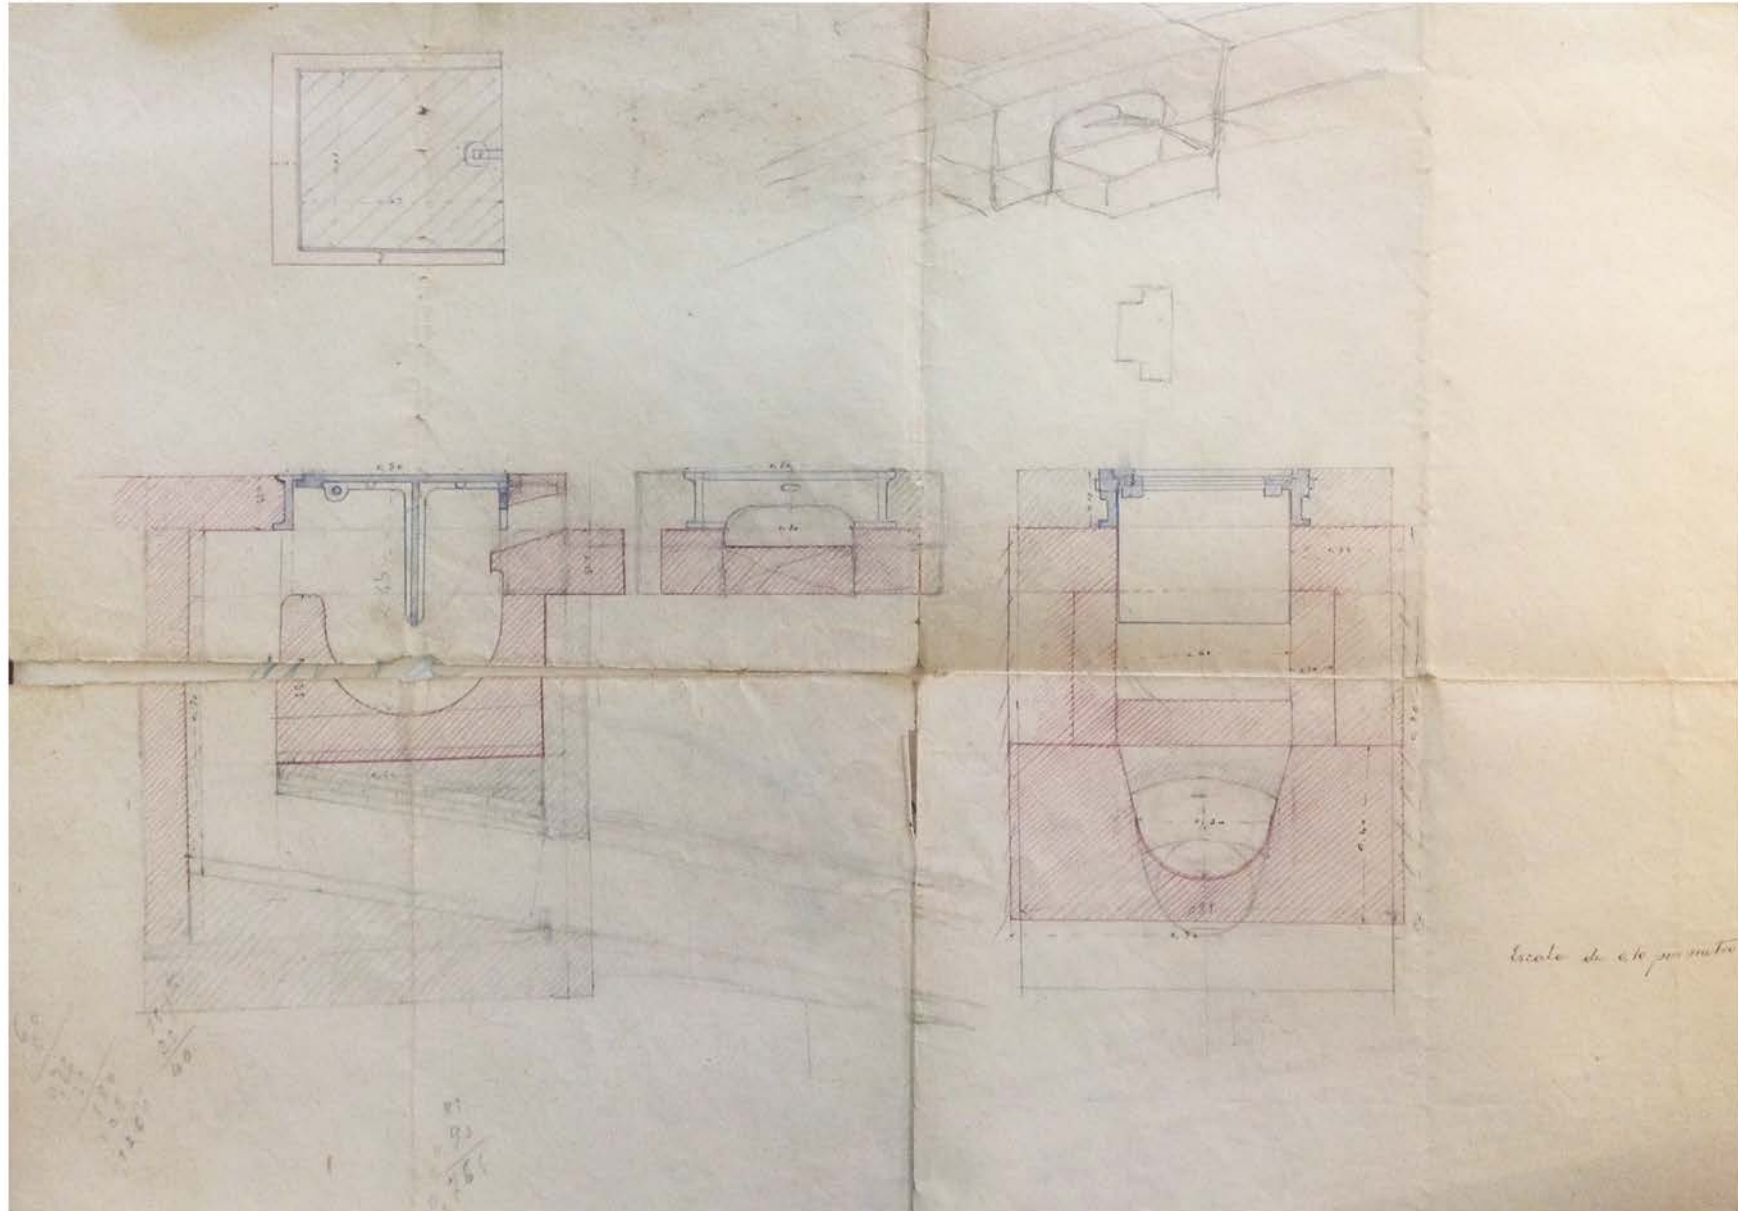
Plano detalle de sumidero y arqueta (s.f., ASM).
